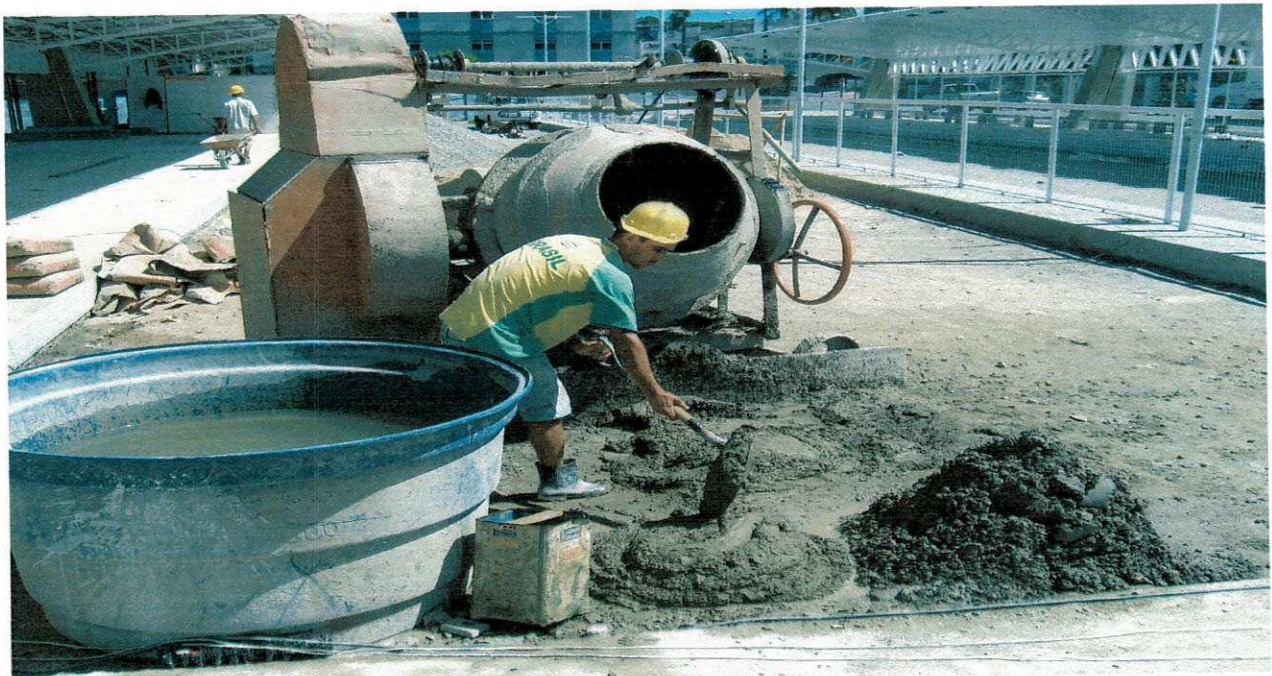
Betoneira utilizada na confecção de concreto e argamassa.
